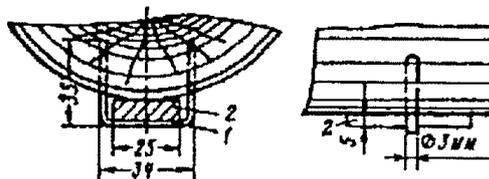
Крепление заземляющего проводника в выработках с деревянной крепью: 1 - стальная скоба; 2 - заземляющий проводник
